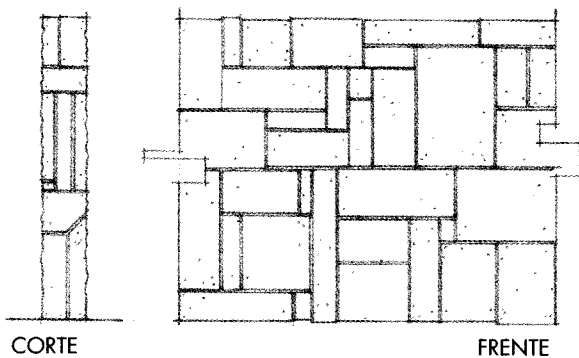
Muro de piedra con cantos labrados regulares y juntas prácticamente sin mortero (a hueso).
